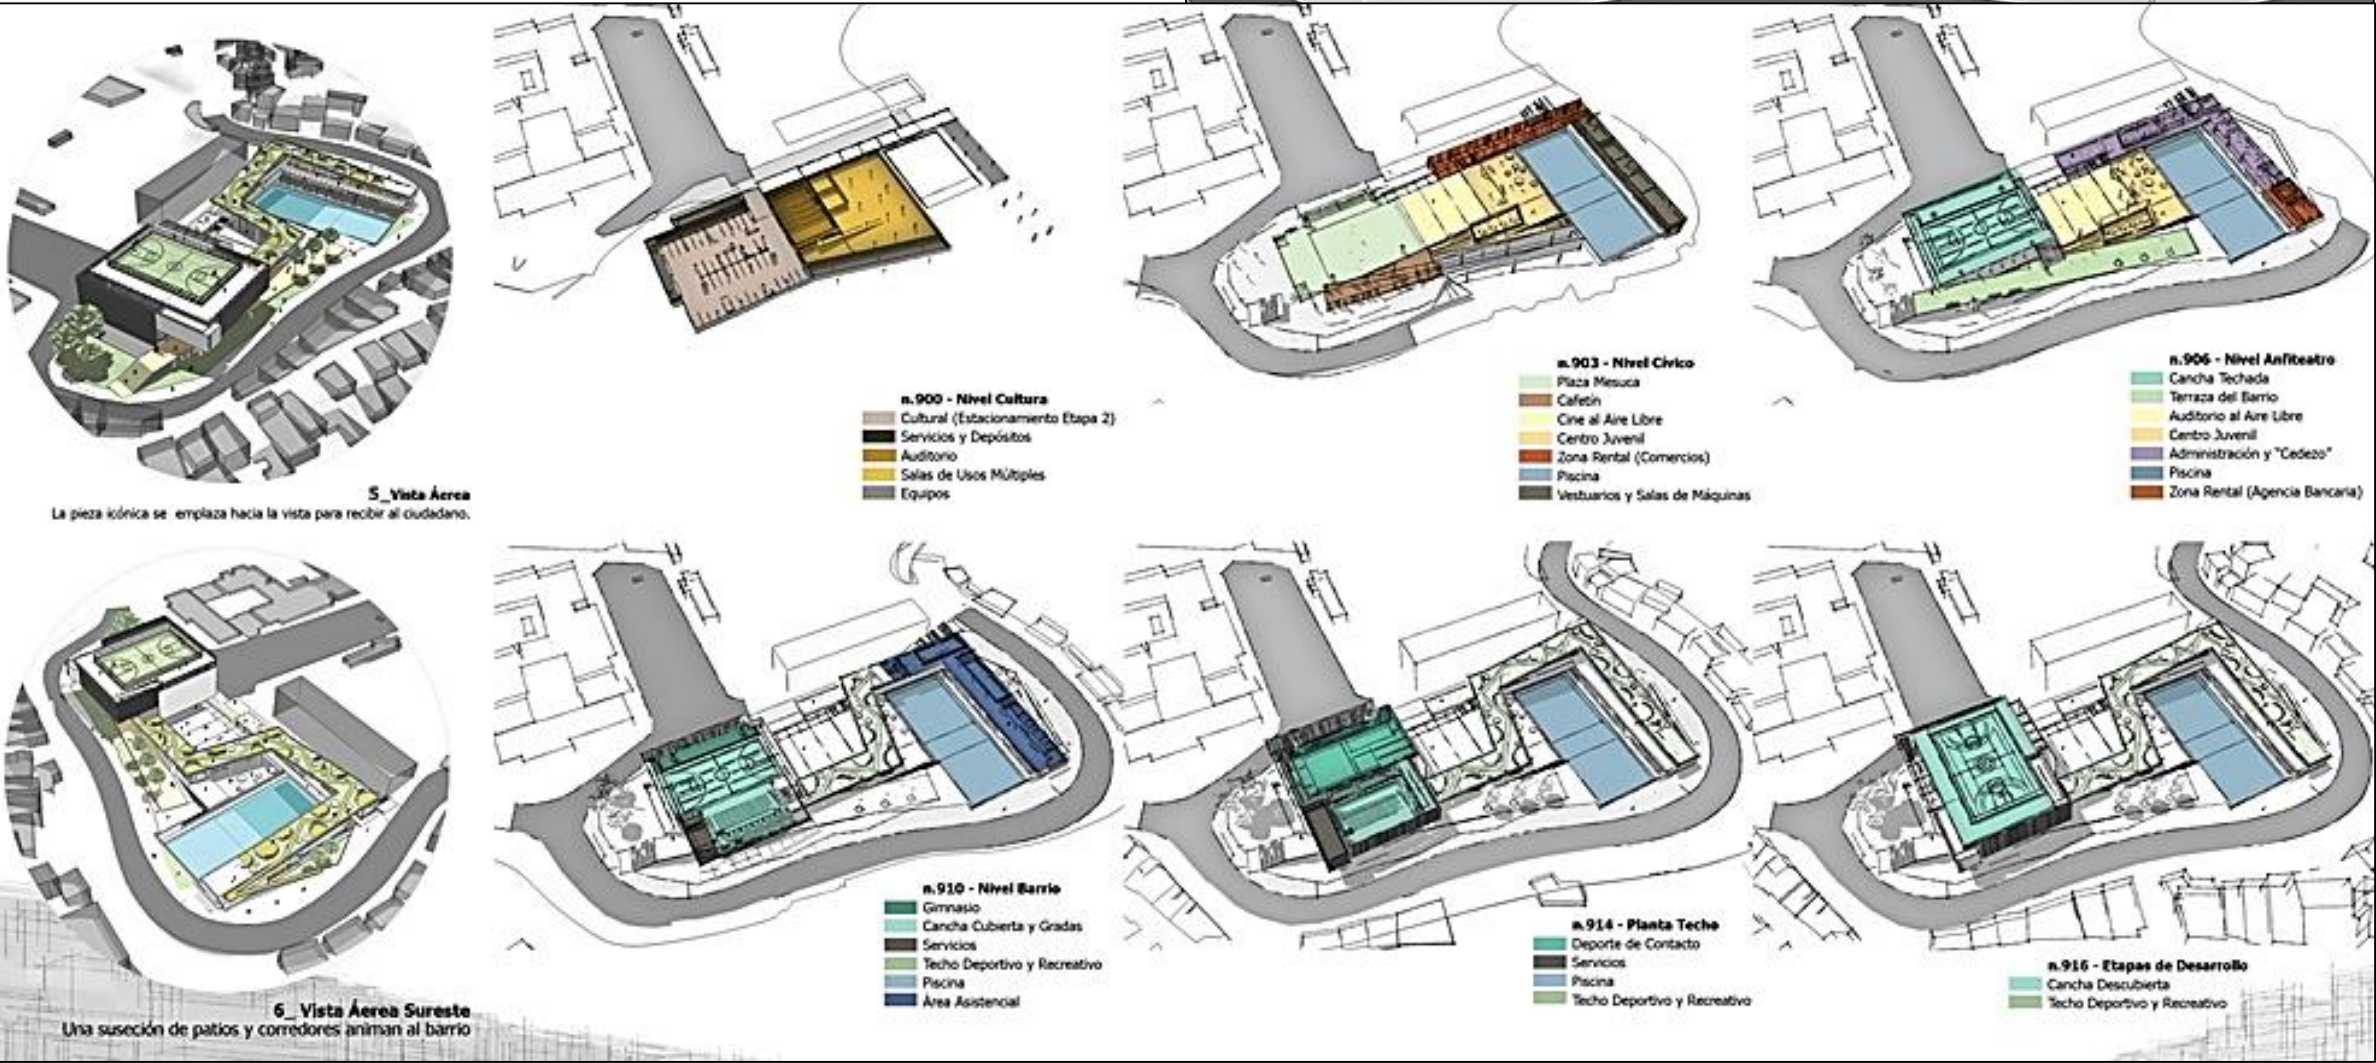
Planta de Techo Parque deportivo Mesuca
